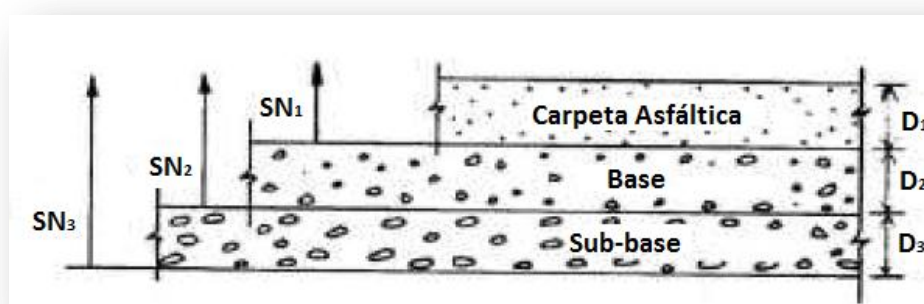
Procedimiento para determinar espesores de las capas de pavimento. Fuente: Guía para pavimentos flexibles de la AASHTO.
